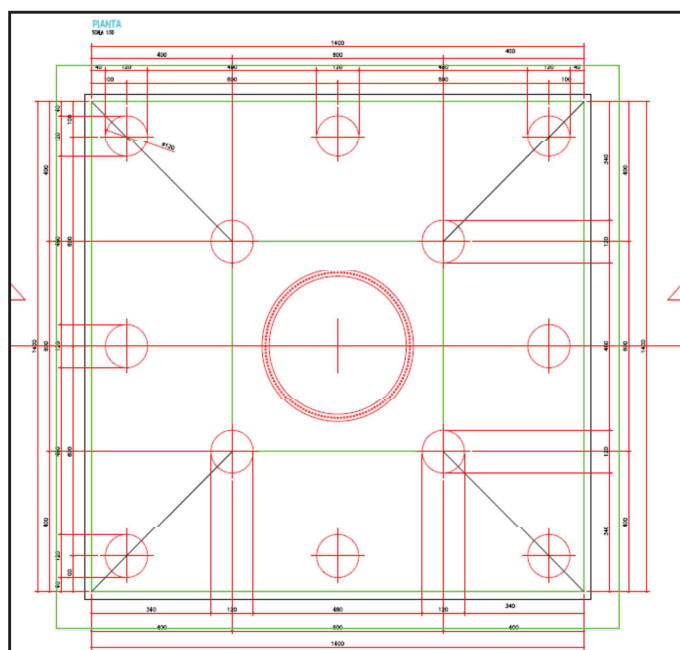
Sezione tipo fondazione degli aerogeneratori.
